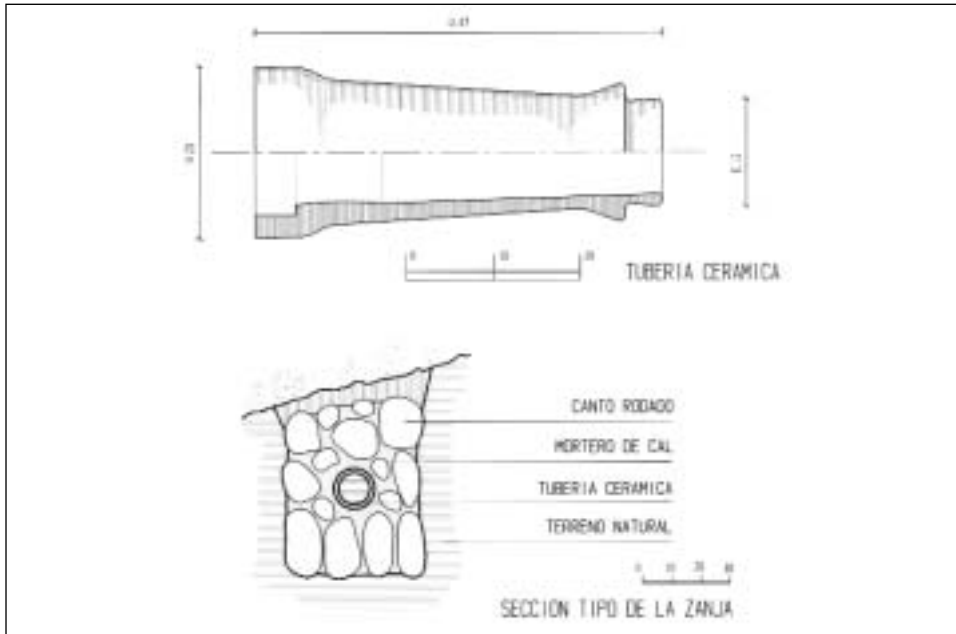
Dimensiones tubería cerámica y sección tipo de la zanja.
